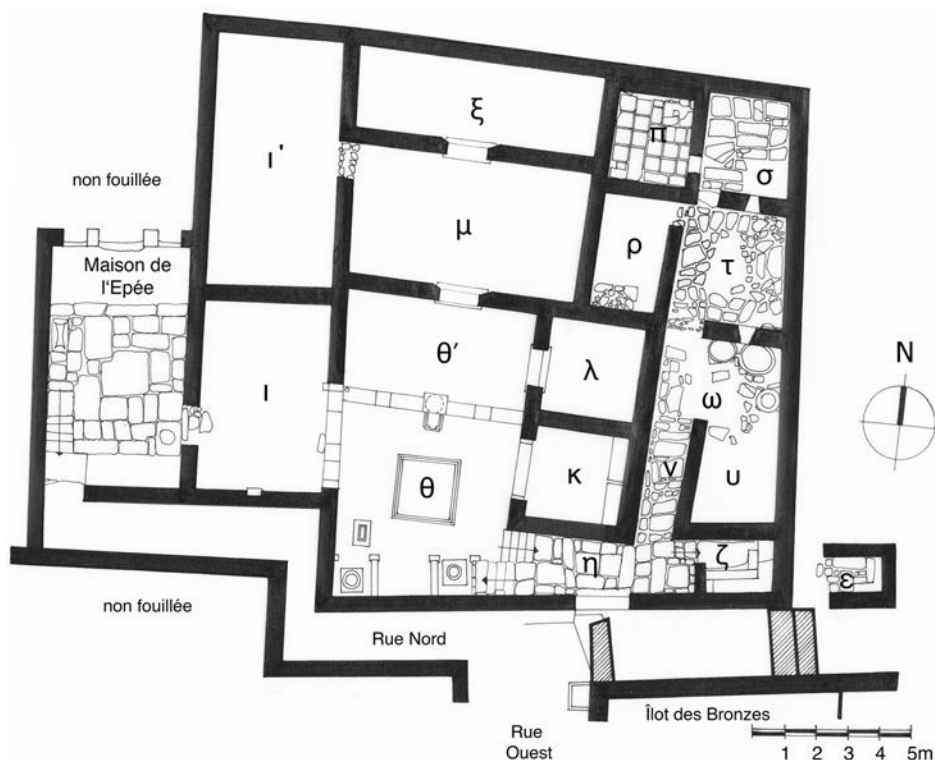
Plan de la Maison des Sceaux (dessin M. Zarmakoupi).
